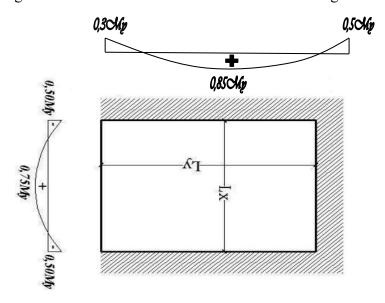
moment d'encastrement de dalle rectangulaire.
